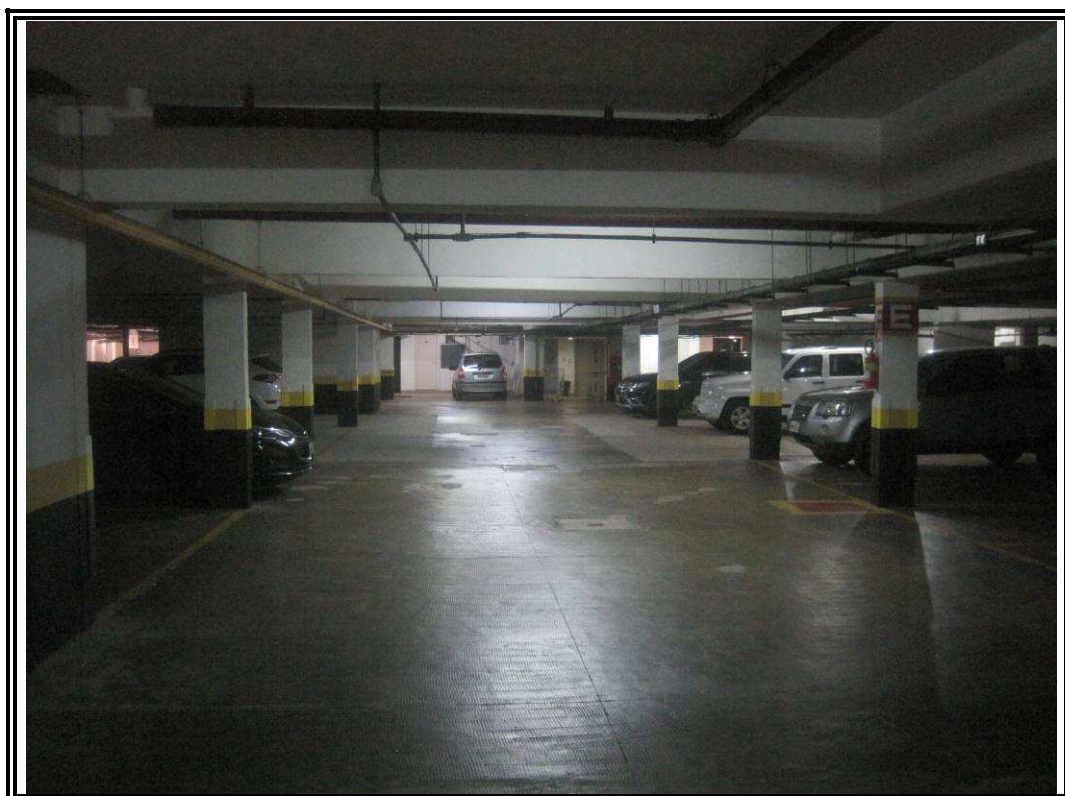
Vista geral da garagem (1º subsolo) do Condomínio
